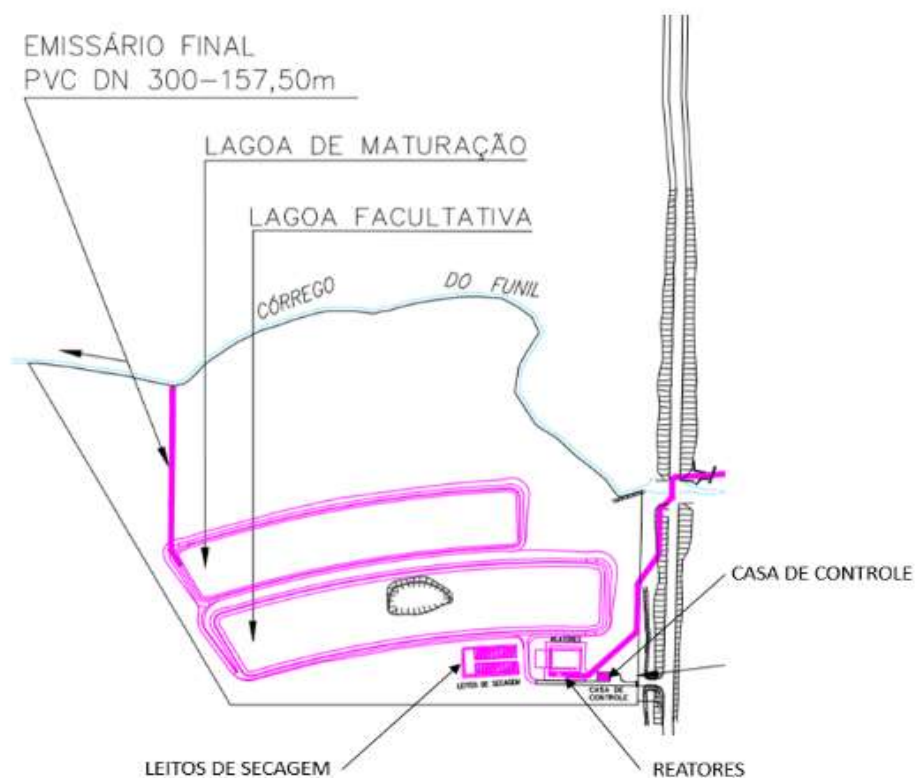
Planta esquemática da concepção do projeto da estação de tratamento de esgoto
